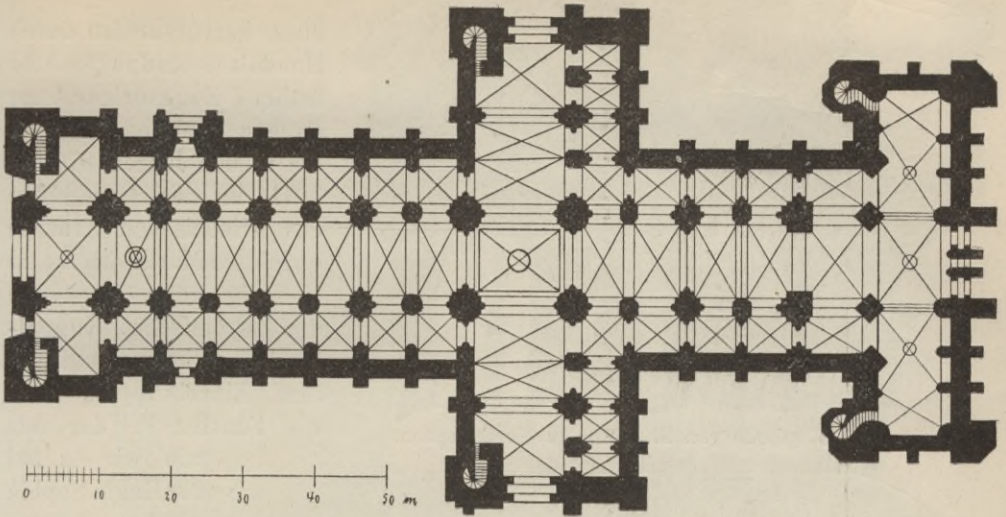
Grundriss der Kathedrale zu Durham (1093).
